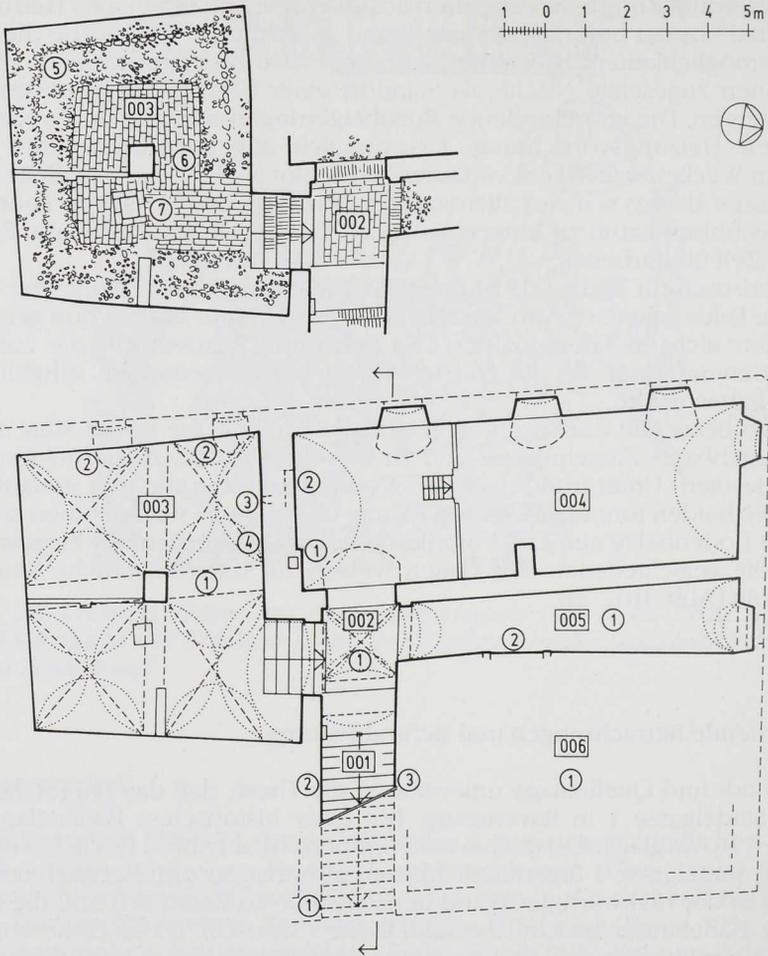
Ravensburg, Stadelgasse 1, Grundriß Untergeschoß.
